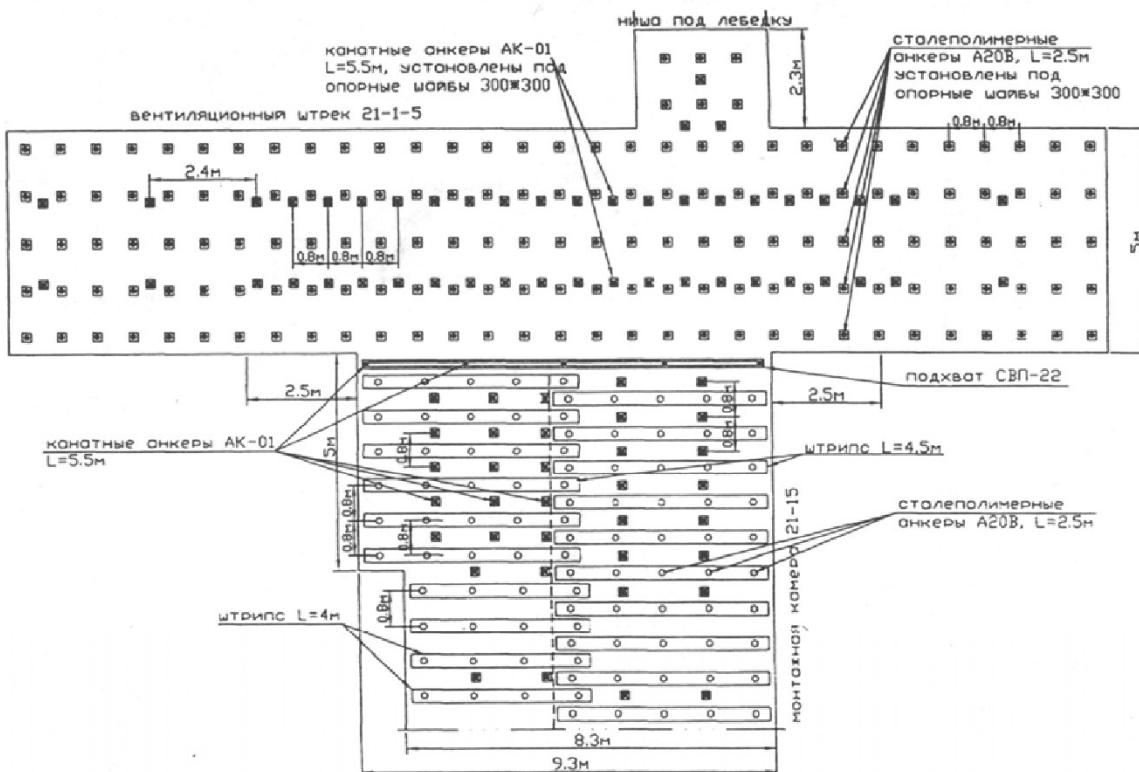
Схема крепления сопряжения монтажной камеры 21-1-5 с вентиляционным штреком 21-1-5
